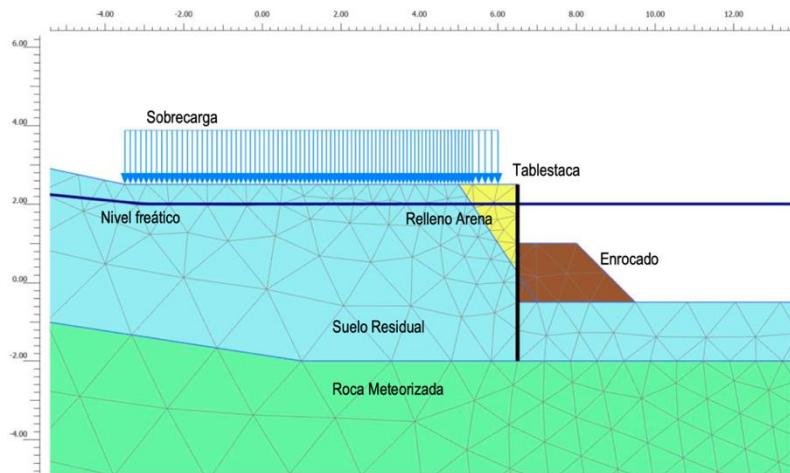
Sección Típica sistema de protección (con Leyenda)
